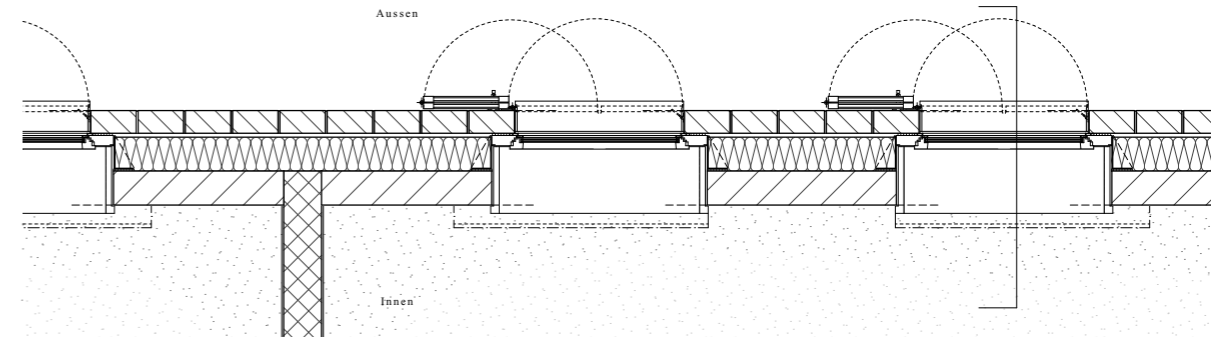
Konstruktive Vertiefung Ostfassade Neubau (Grundriss, Leibungsdetail, U-Wert Berechnungen)
